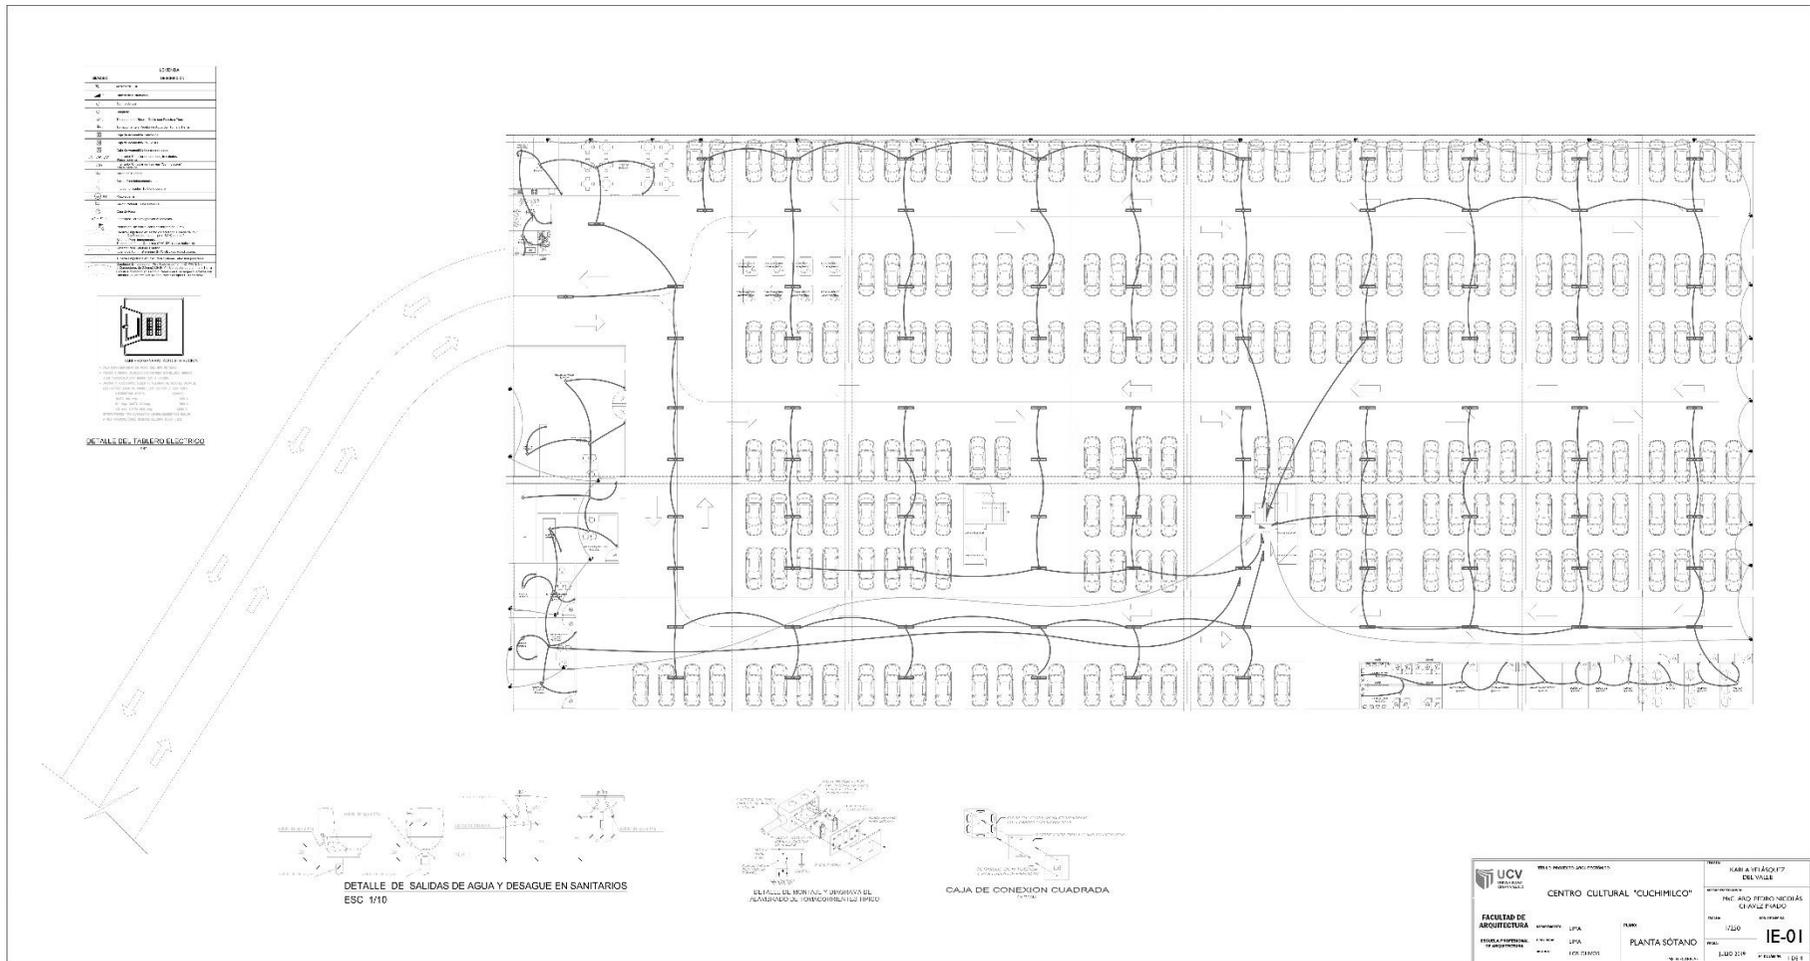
Plano Eléctrico Planta Sótano. Elaboración propia
